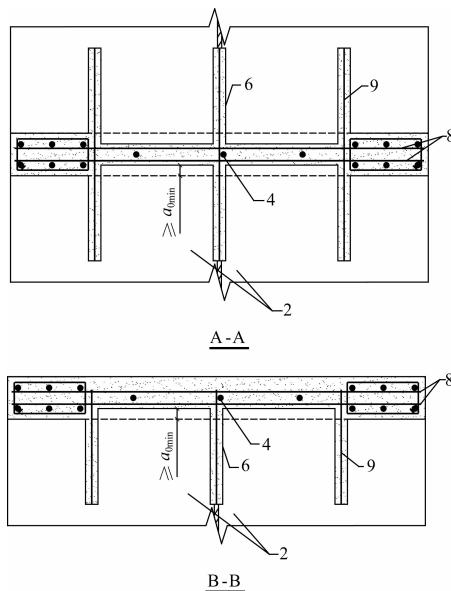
配预应力空心叠合楼板装配整体式剪力墙构造示意图
